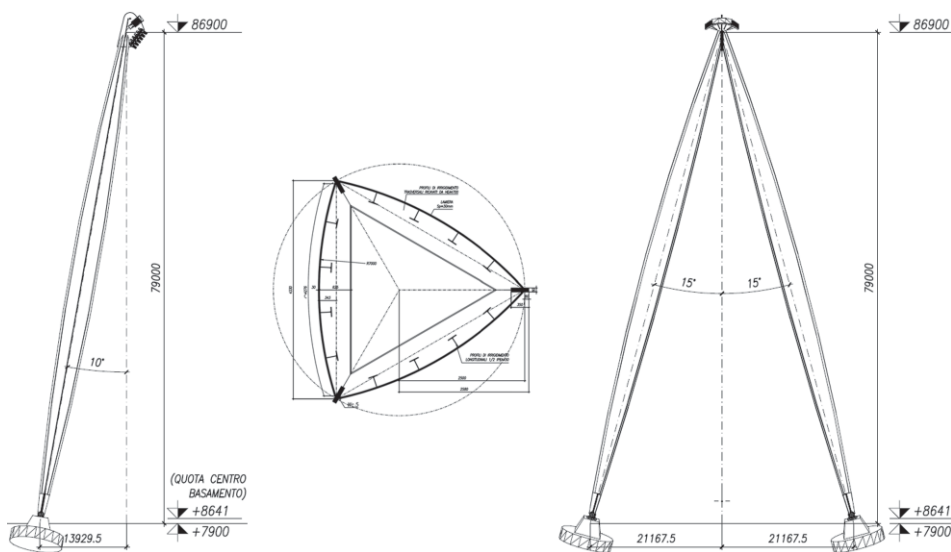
Vista di profilo, sezione e prospetto del pilone dello stadio
